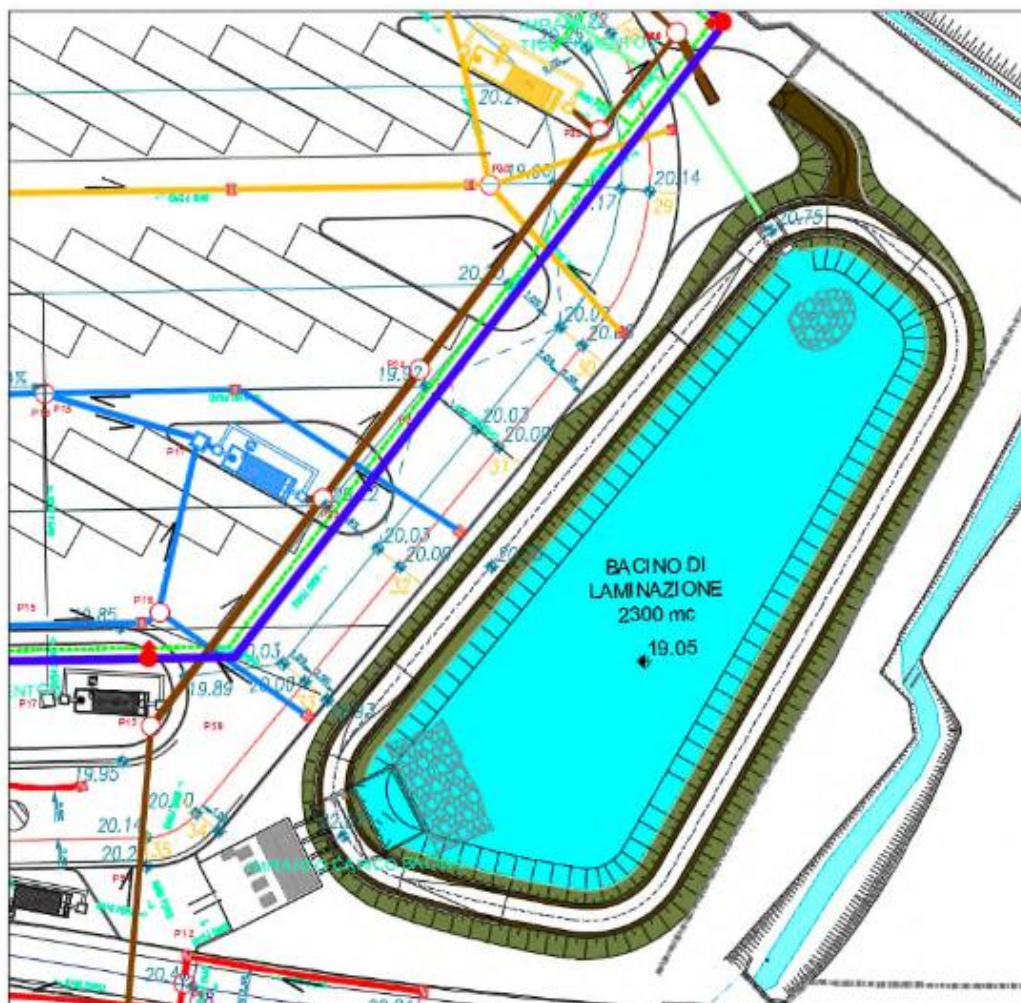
Planimetria di collettamento acque meteoriche al bacino di laminazione
